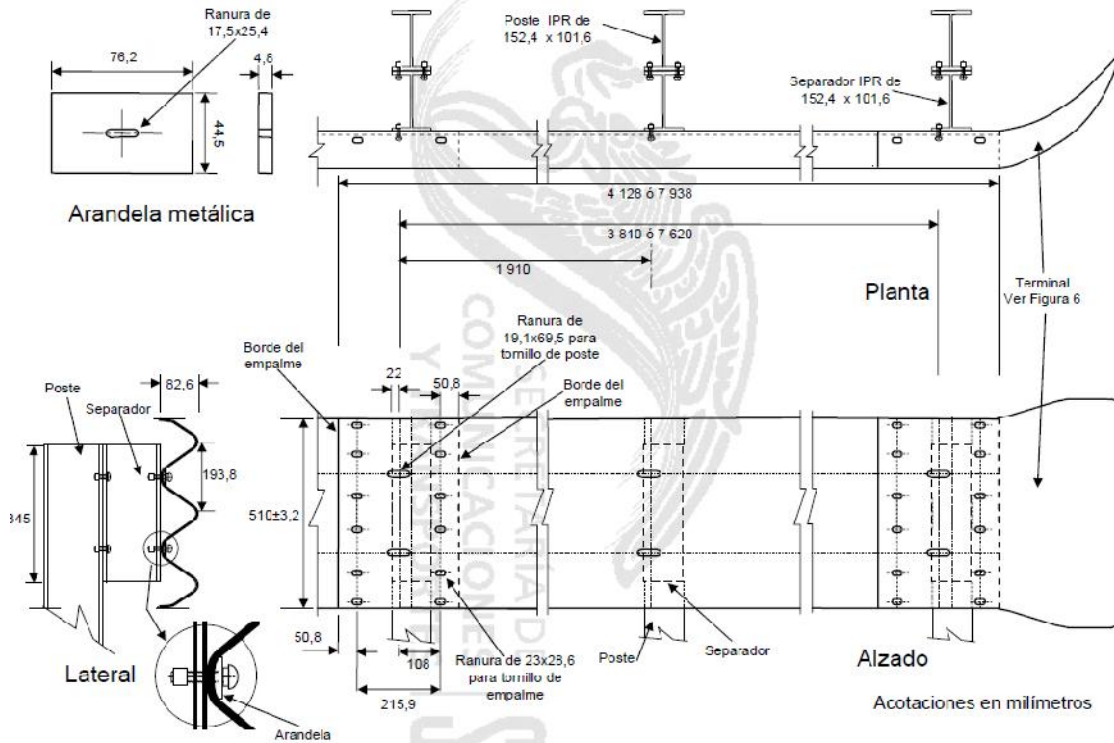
Sistema de defensa con vigas acanaladas de dos crestas
